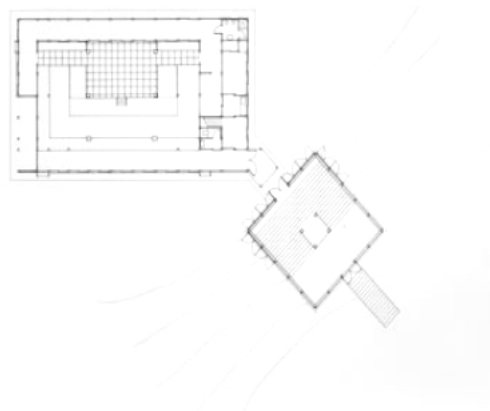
Shin Toga Sanbo (1982) e a planta baixa do teatro e do hall de entrada.
